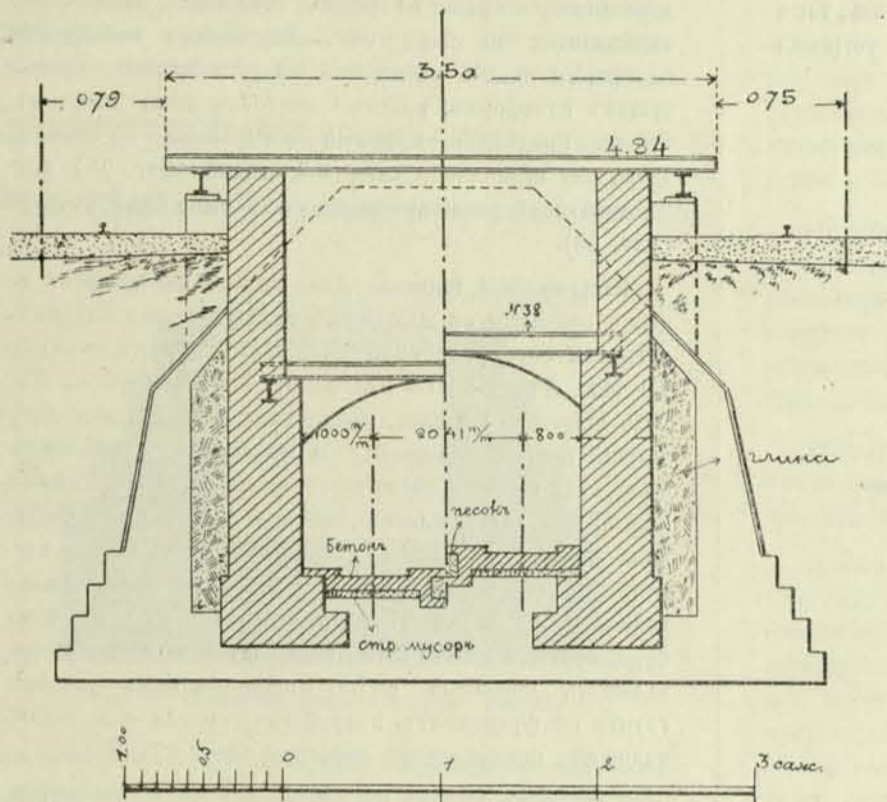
Продольный разрѣзъ поперечнаго багажного тоннеля.
